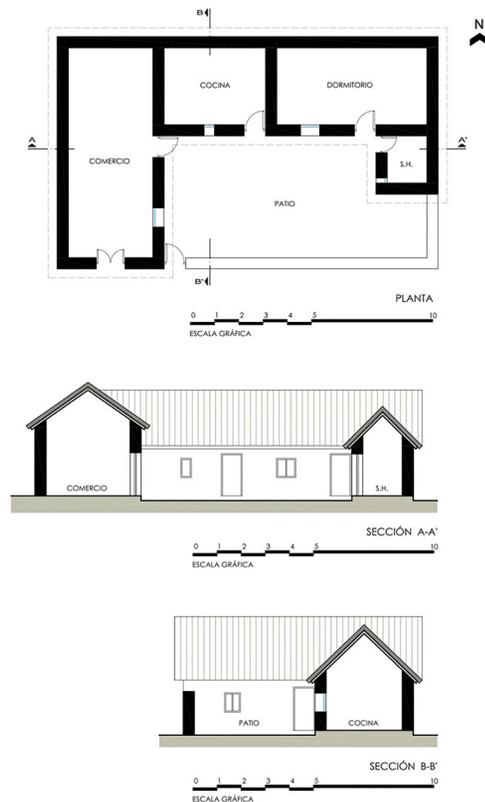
Planta y secciones de modelo de vivienda típica del Valle del Colca
